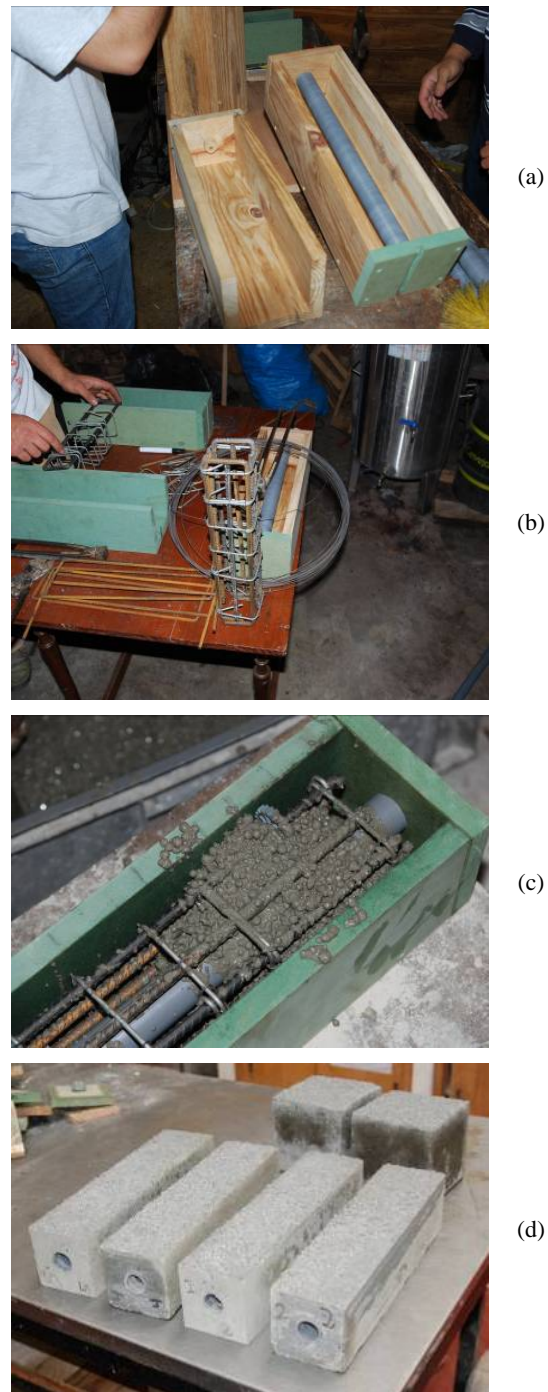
Construção dos elementos pré-fabricados: (a) molde; (b) armaduras dos blocos extremos; (c) betonagem de um bloco extremo; (d) aspecto final dos blocos.
